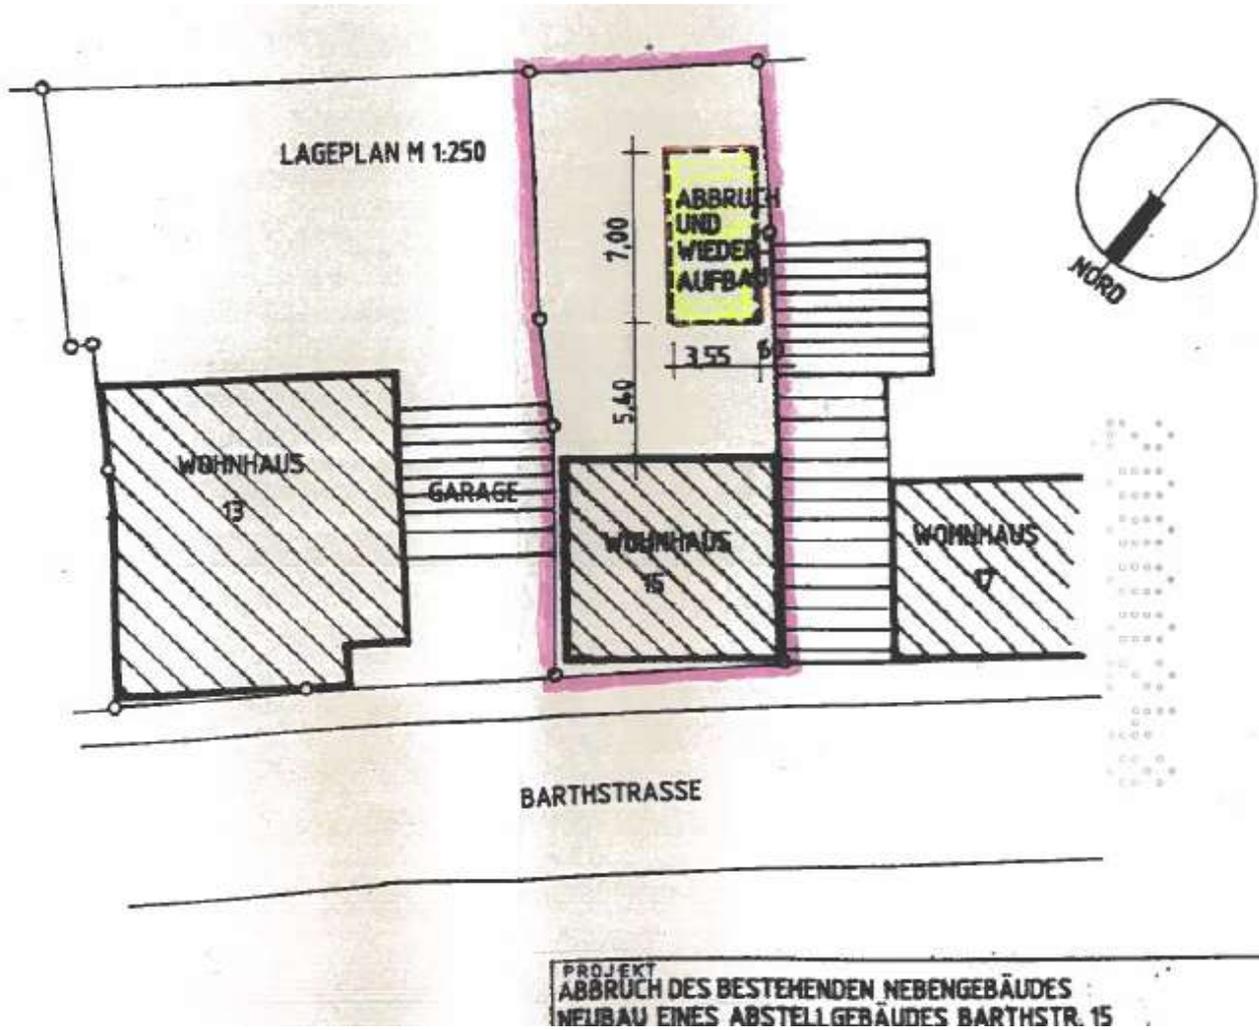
Lageplan der Gebäude; Quelle: Bauakte, Baugesuch zum Abbruch und Neubau eines Abstellgebäudes
